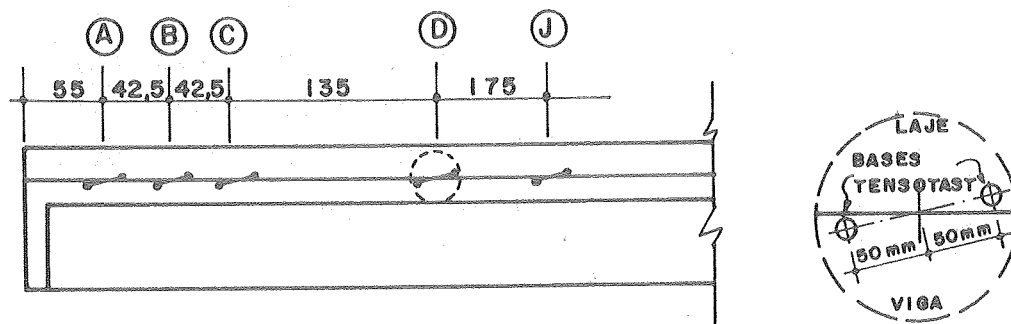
INSTRUMENTAÇÃO DA JUNTA VIGA PRÉ-MOLDADA - LAJE COLABORANTE COM BASES TENSOTAST
